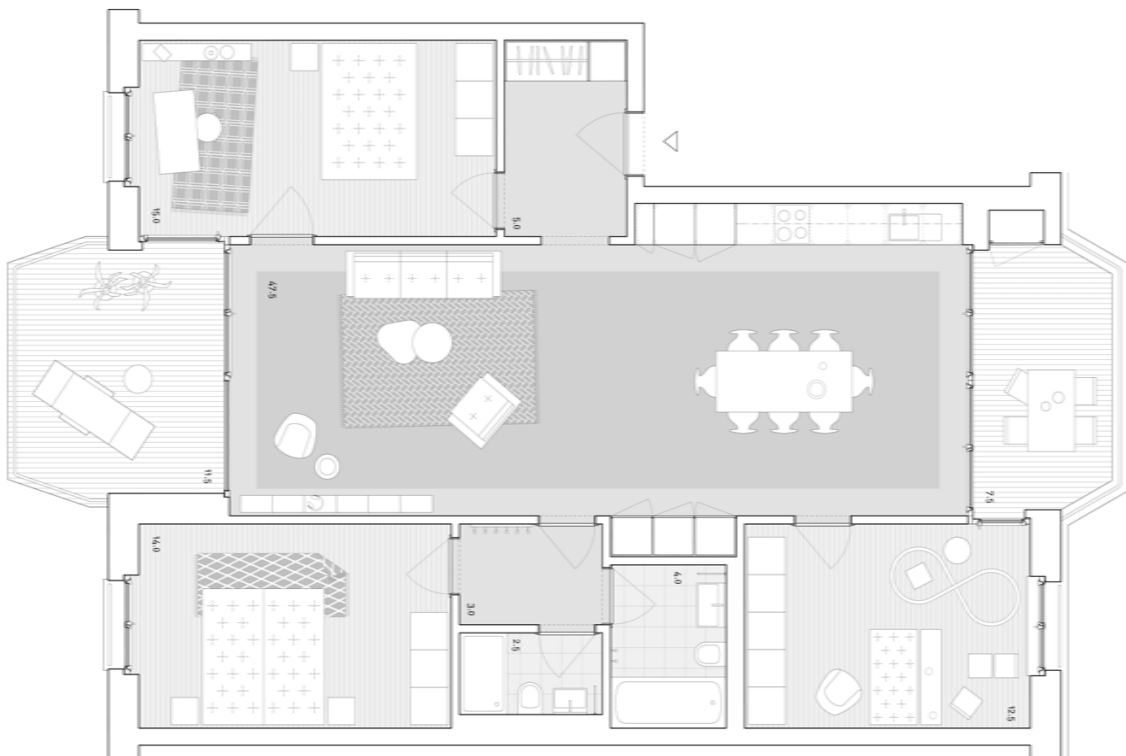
Penelope: Wohnungsgrundriss 4.5-Zimmer-Whg.
